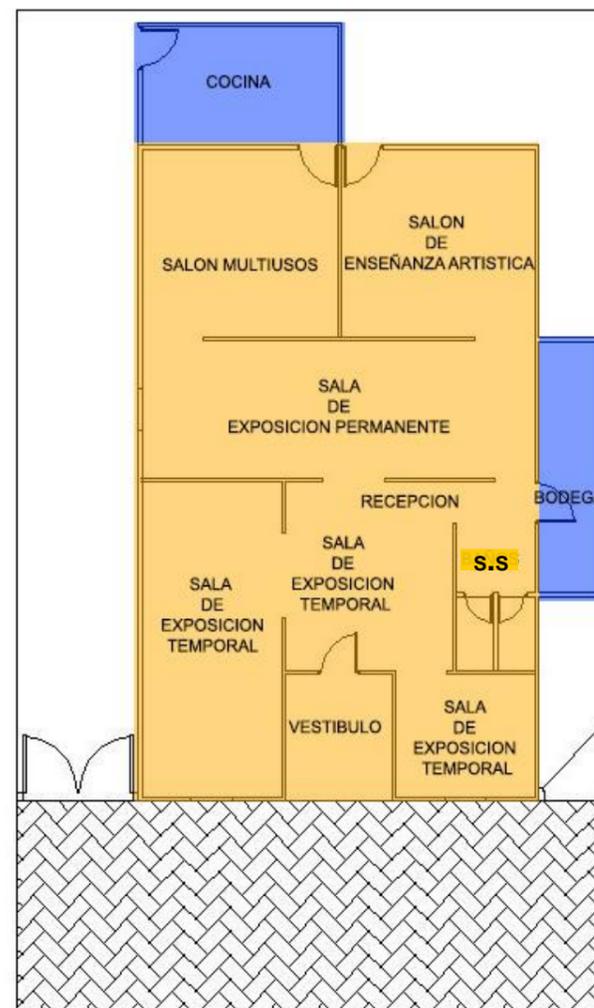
Plano de Zonificación Galería Allegro. Fuente: Propia
